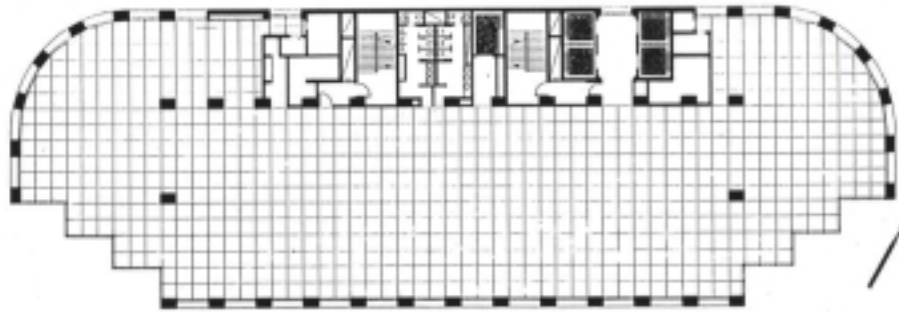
Planta pavimento tipo 14º ao 16º
